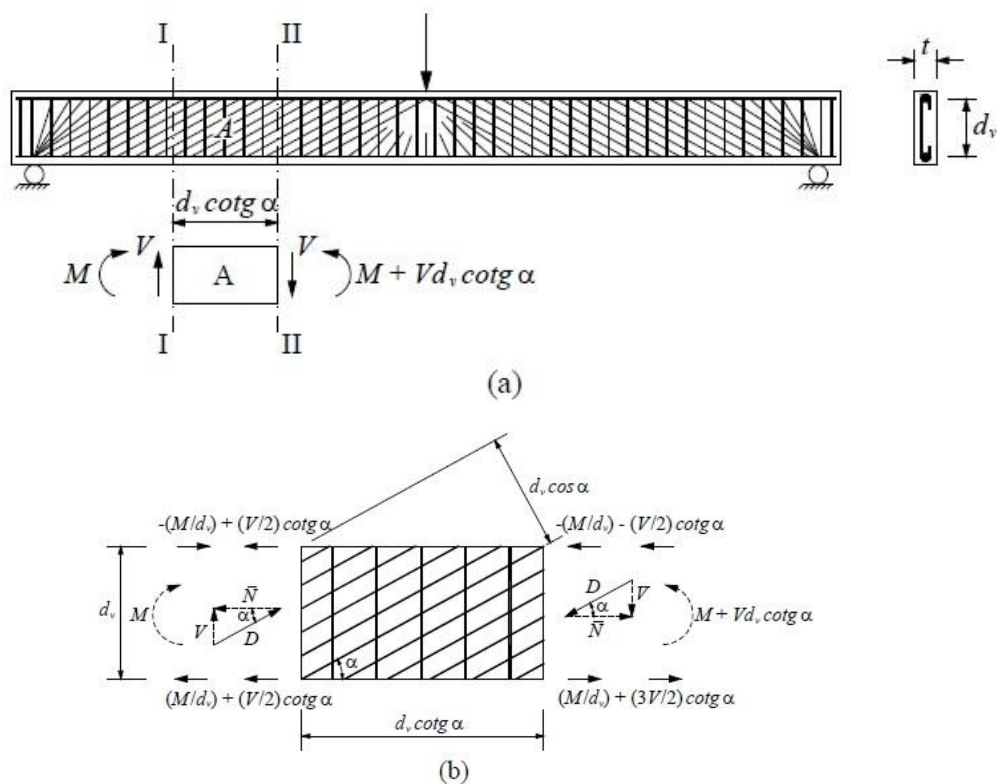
Análise de uma viga com base no modelo de treliça plana [10]
